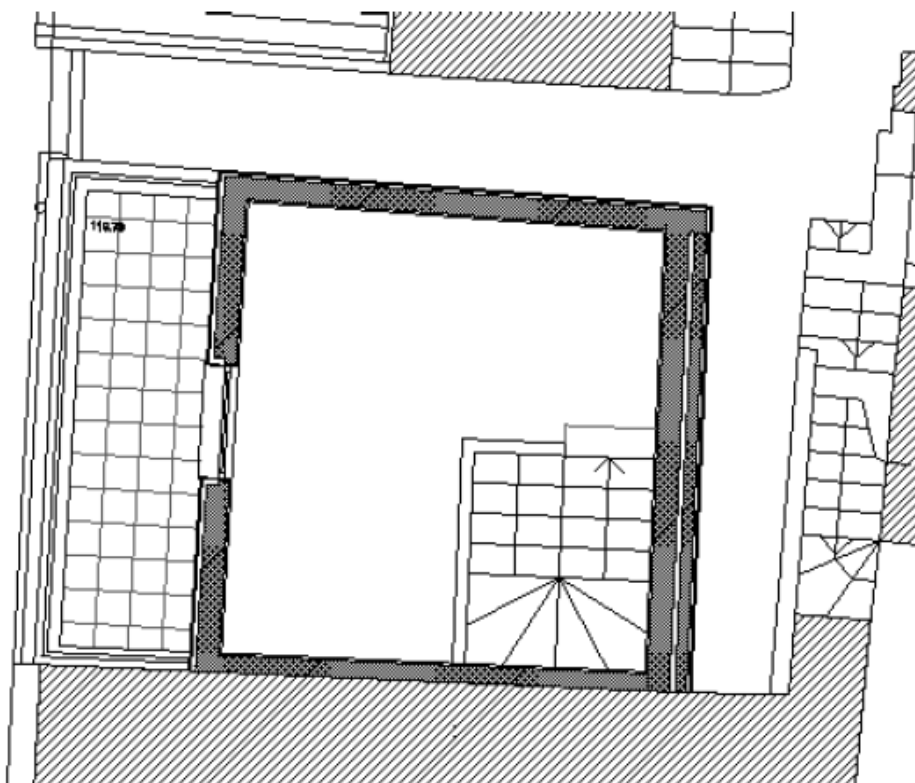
Planta do edifício Cedofeita: Piso 2
